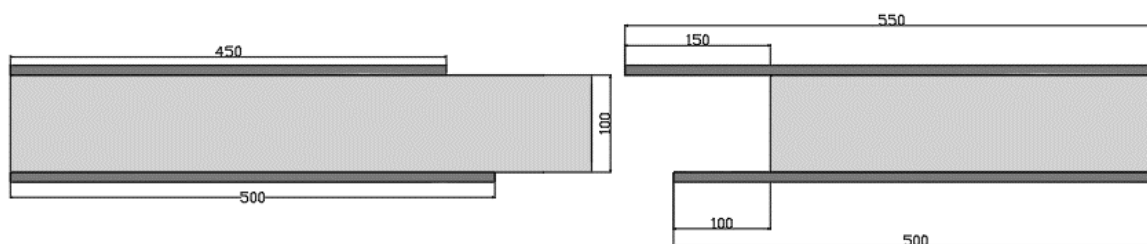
Vista em planta do protótipo 1 (fase inicial).
